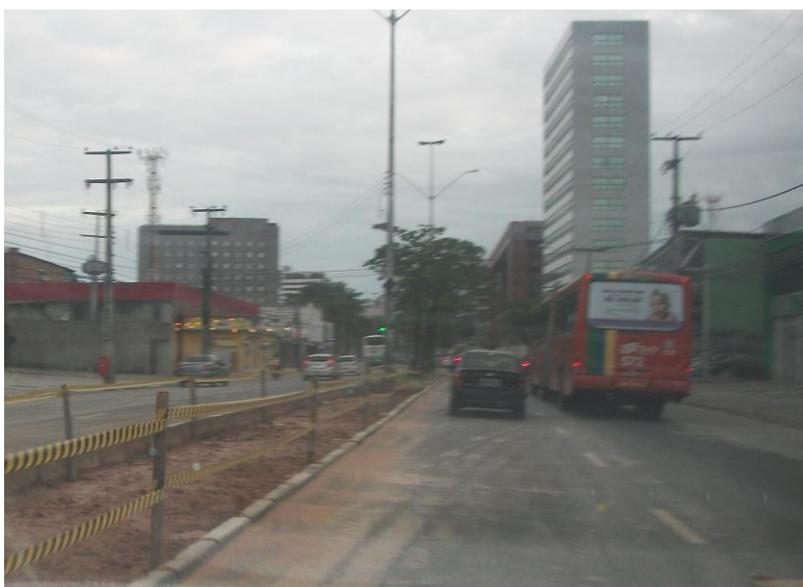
Obras de retirada do canteiro central da Av. Domingos Ferreira
